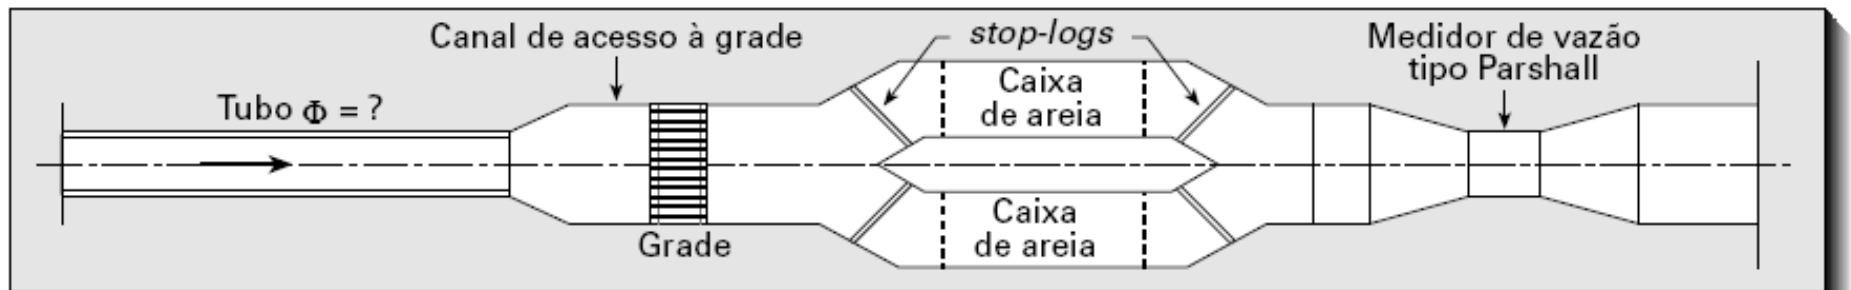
Planta esquemática da entrada da ETE (sem escala).
